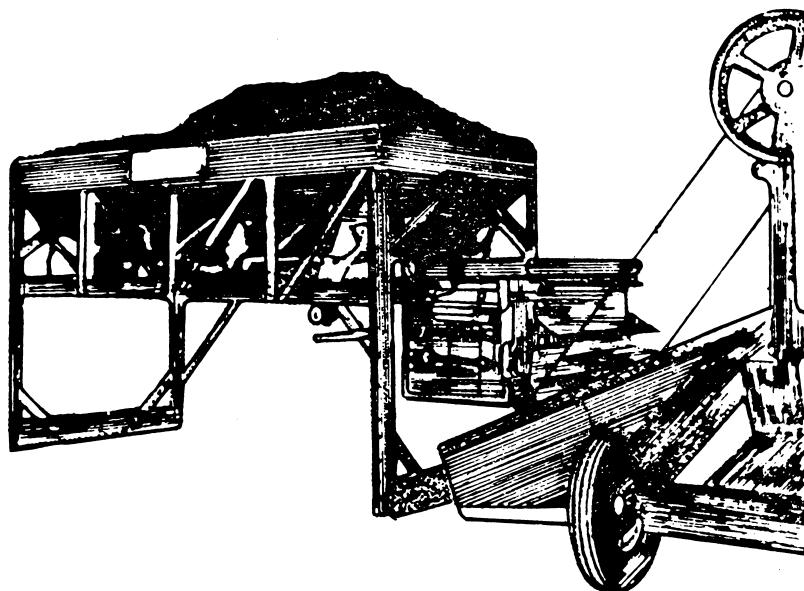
Planta dosificadora de hormigón hidráulico.
